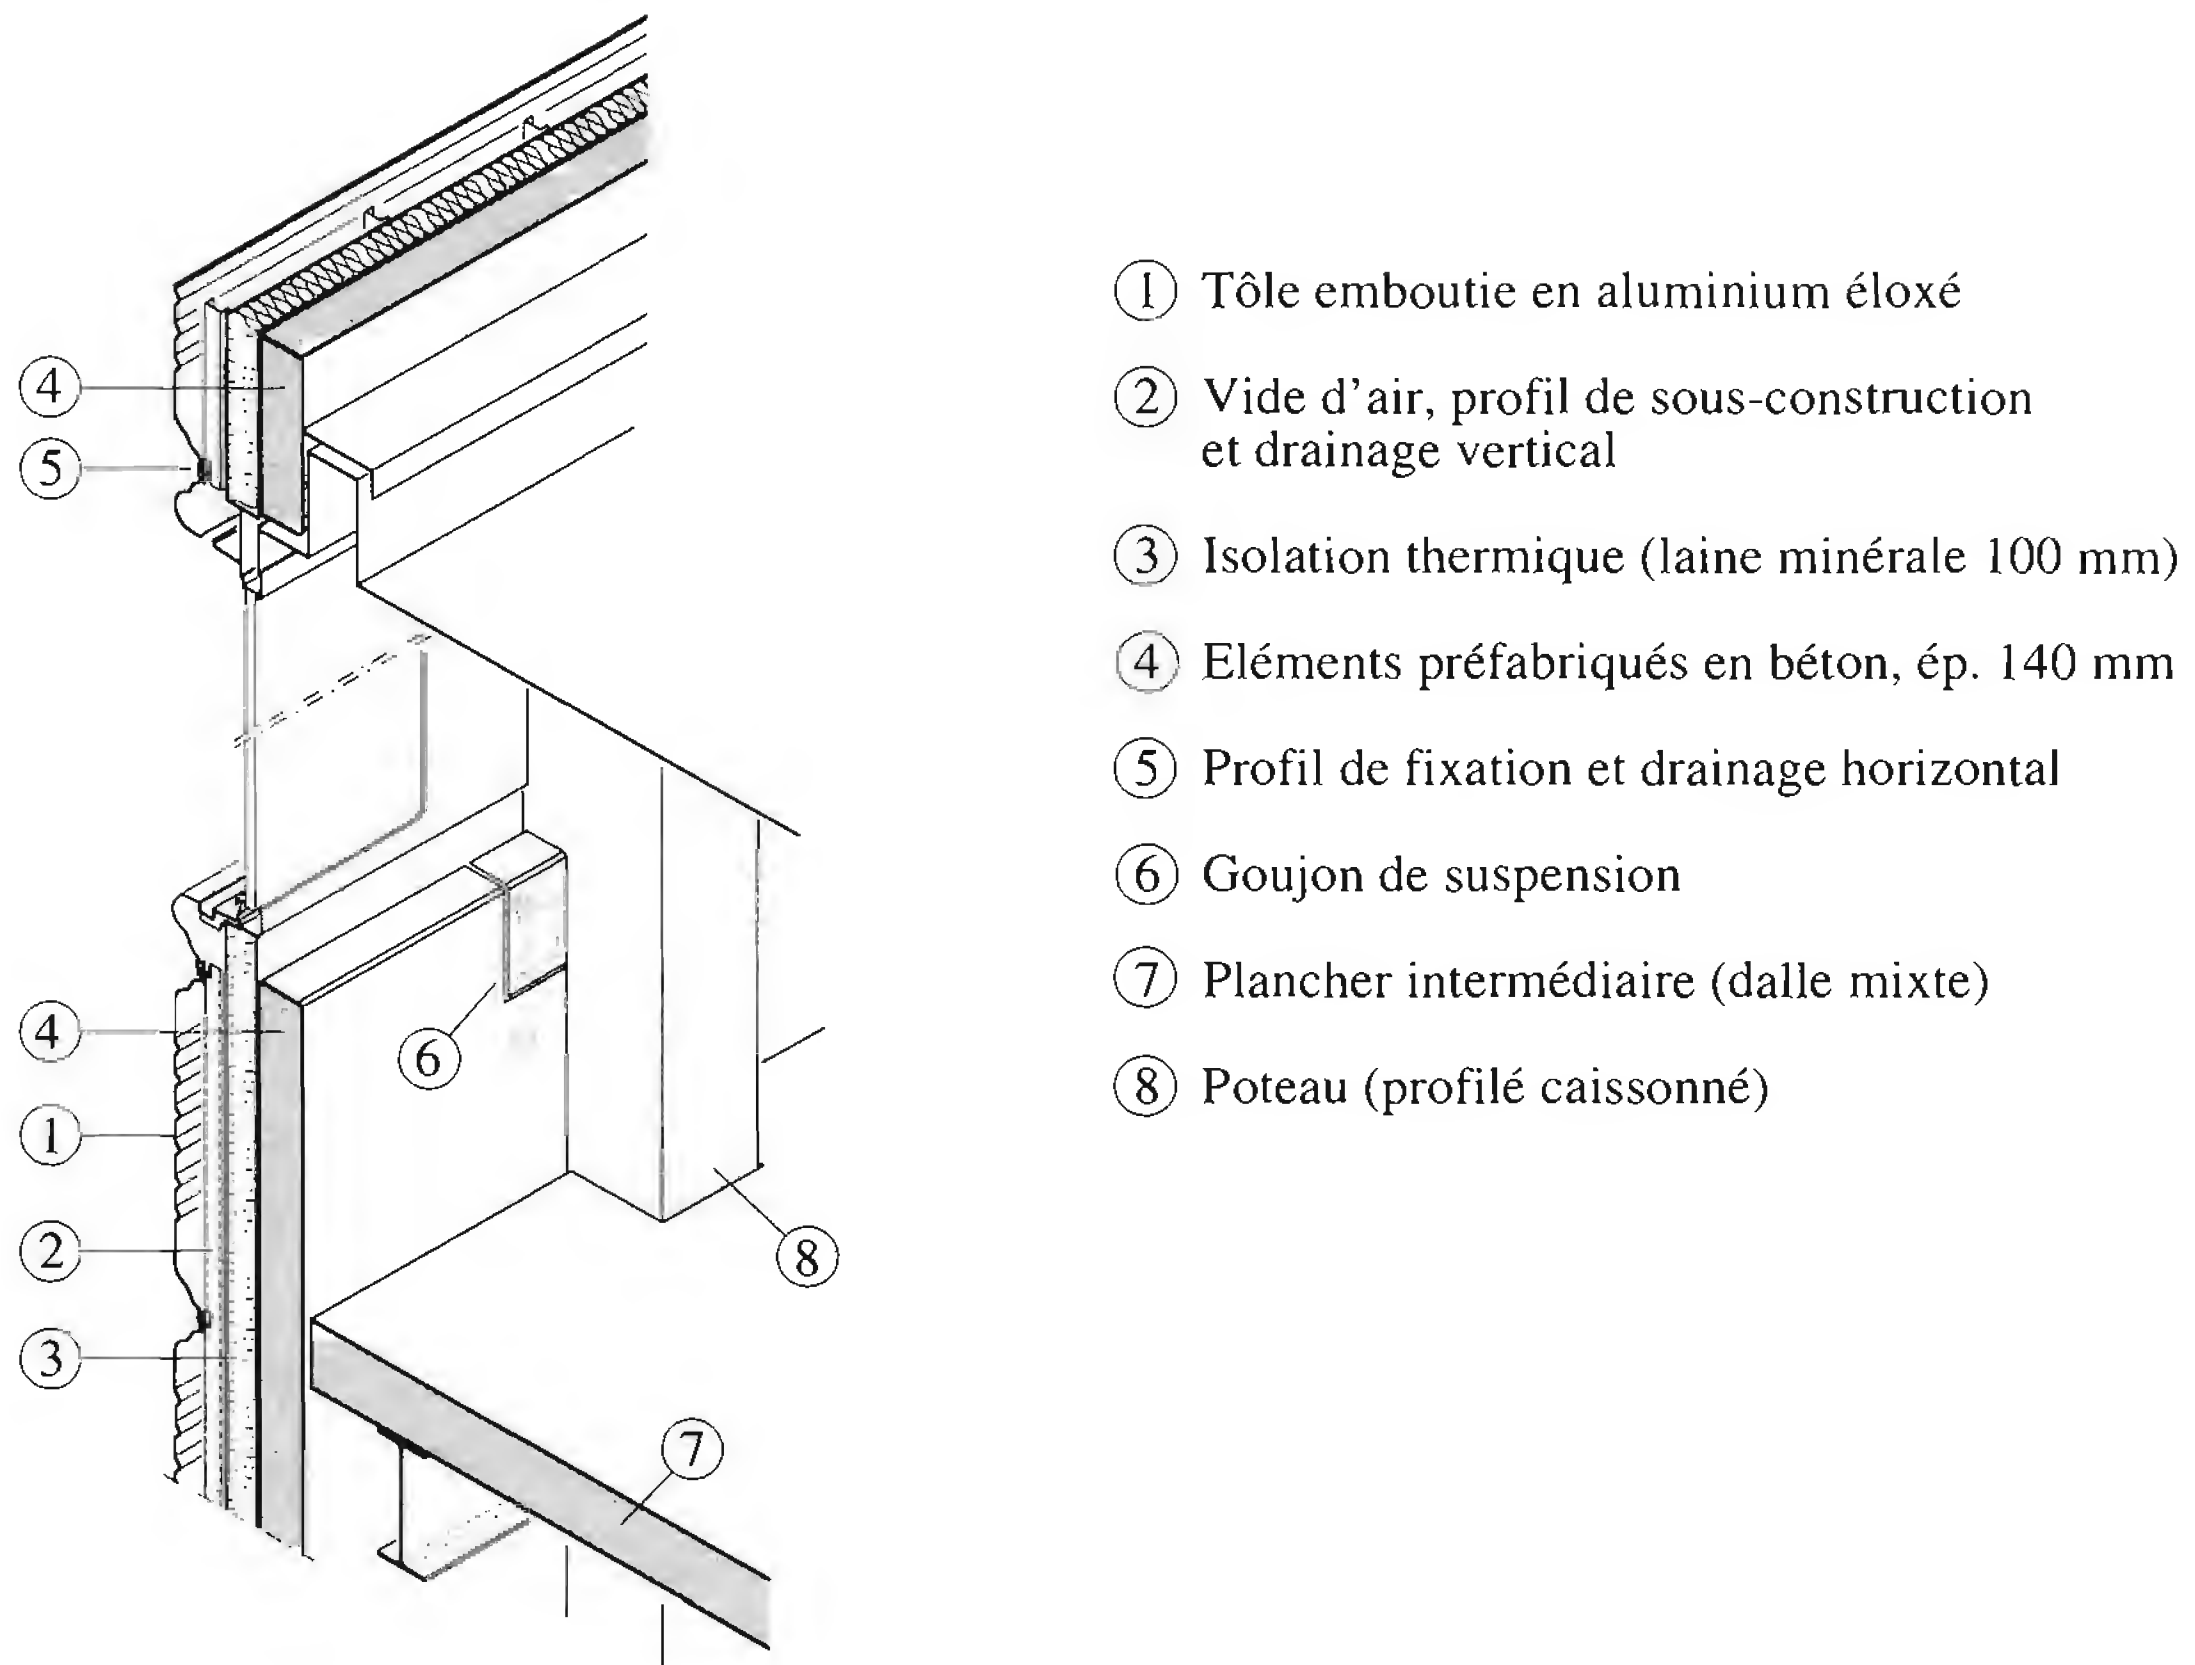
Exemple d'une façade de bâtiment avec panneaux préfabriqués en béton (bâtiments de l'EPFL, 1^{ère} étape).
